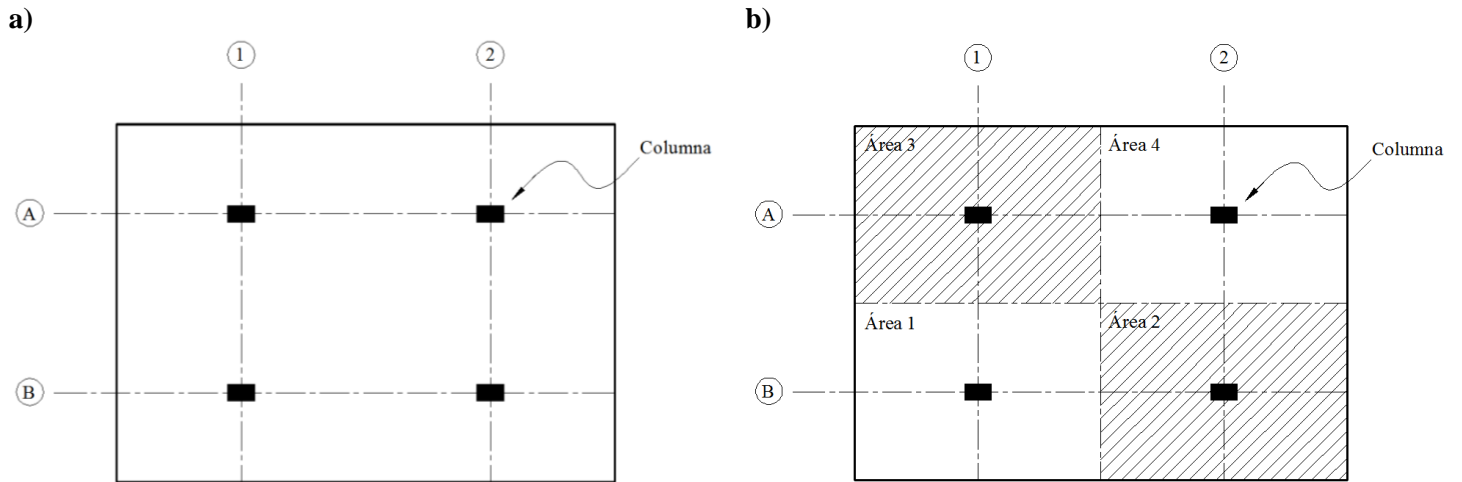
3. Planta del cajón de cimentación a) real y b) subdividida.
